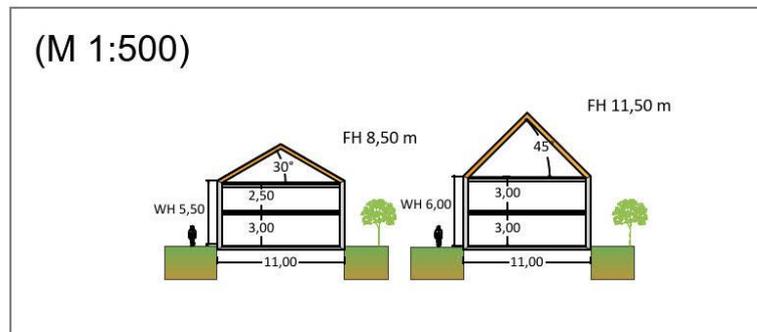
skizzenhafte Darstellung der Haustypen Typ B, jeweils nur mit Satteldach und einer Dachneigung von 30°-45°
